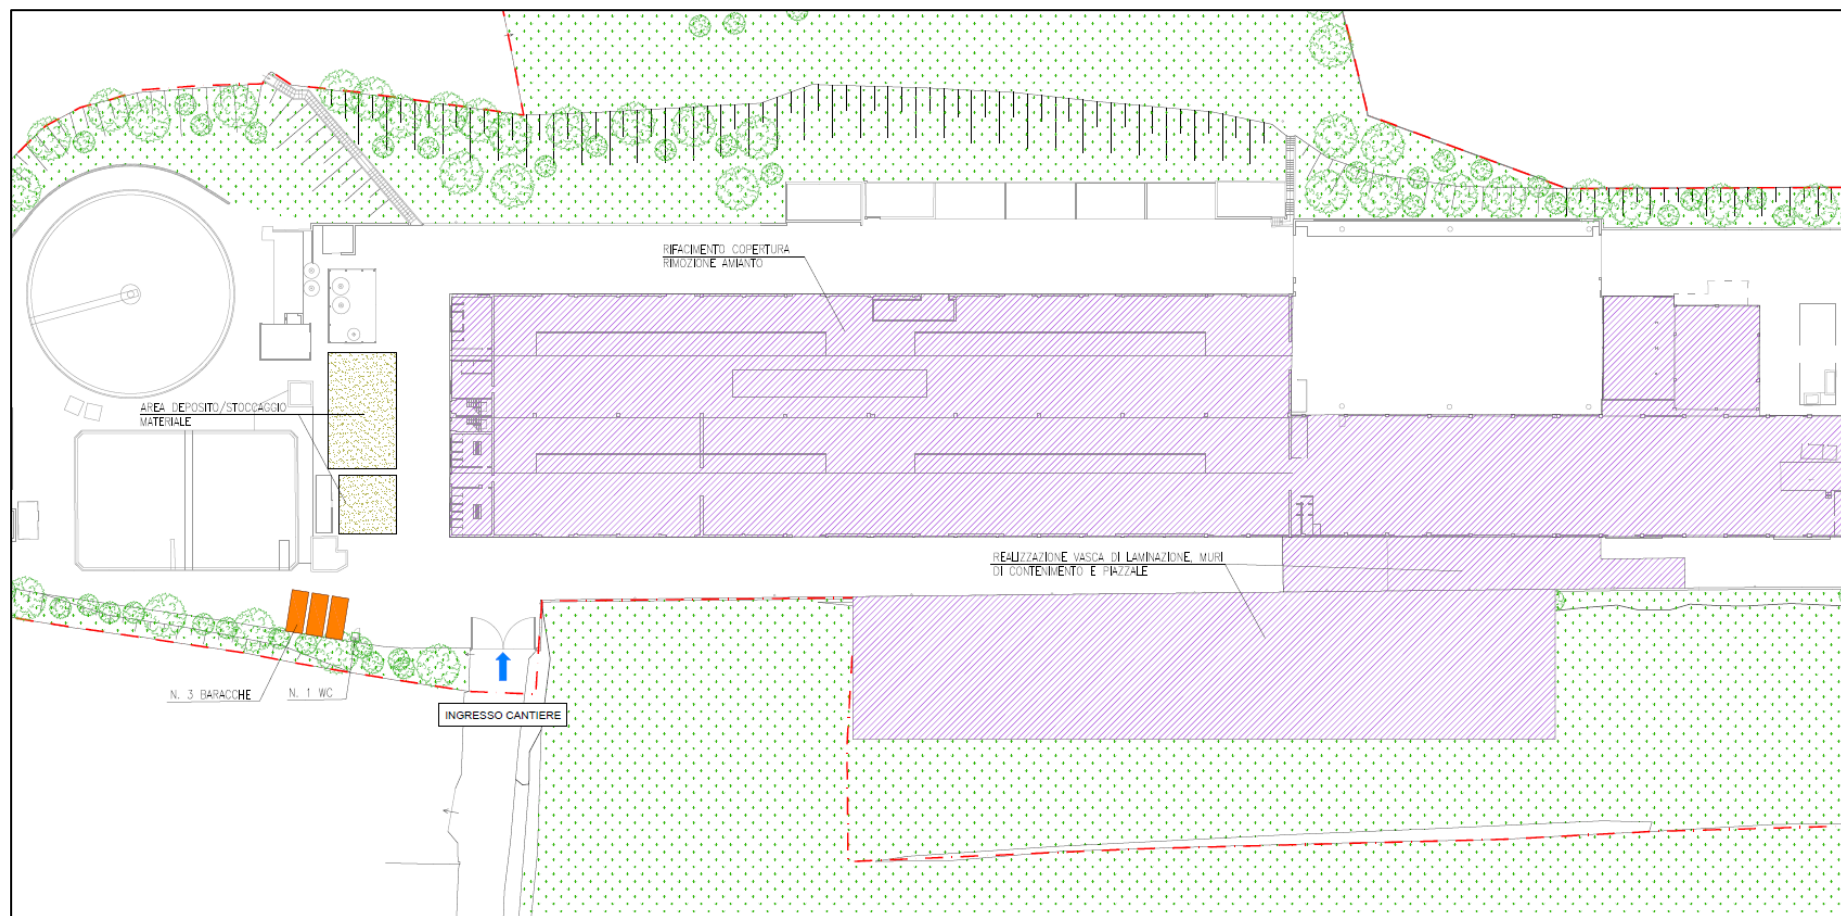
Planimetria area di cantiere durante le fasi di cantiere numero 1 e 2 [Fonte: stralcio elaborato PD A.3]
